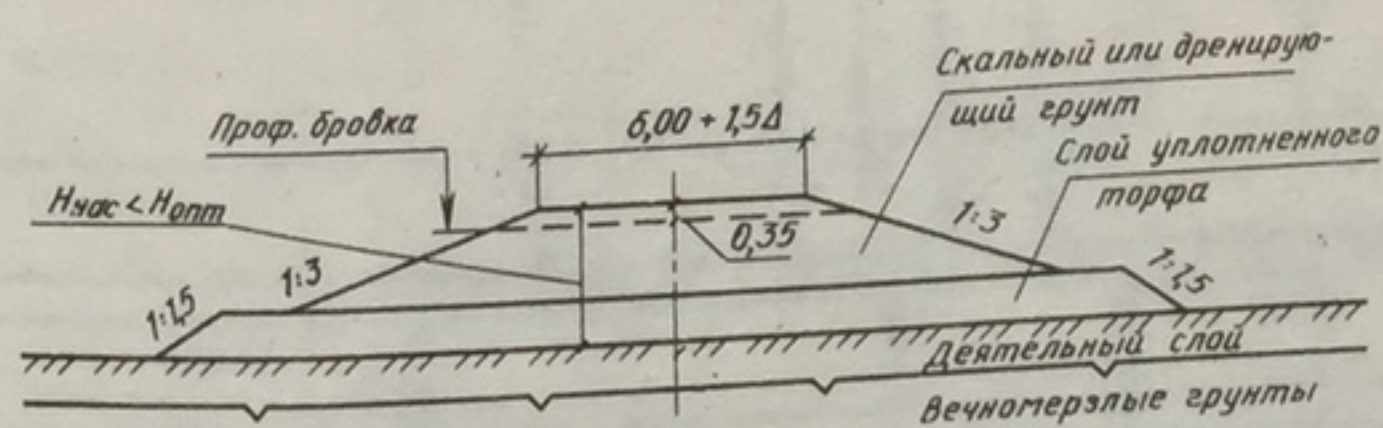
Поперечный профиль насыпи высотой менее оптимальной с укладкой в ее основание теплоизолирующего материала
